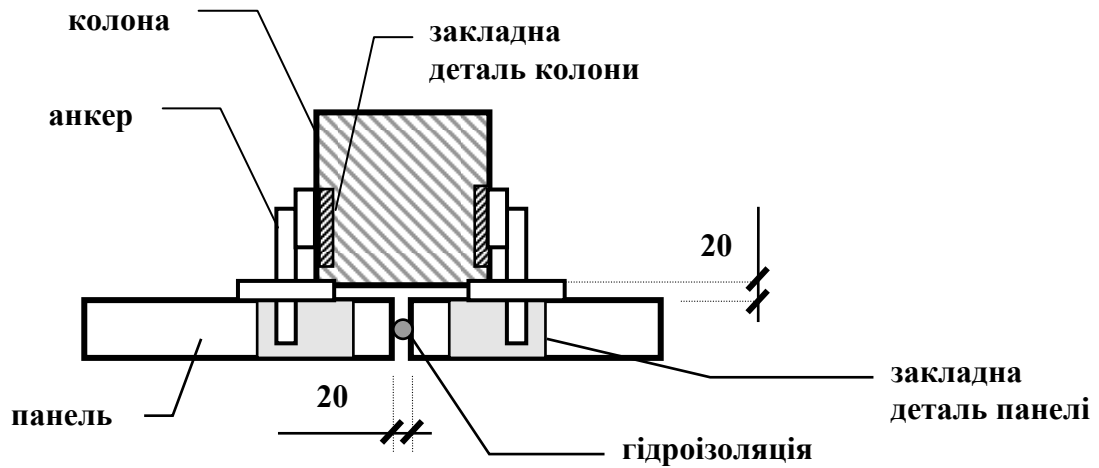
Вузол кріплення стінової панелі до колони
